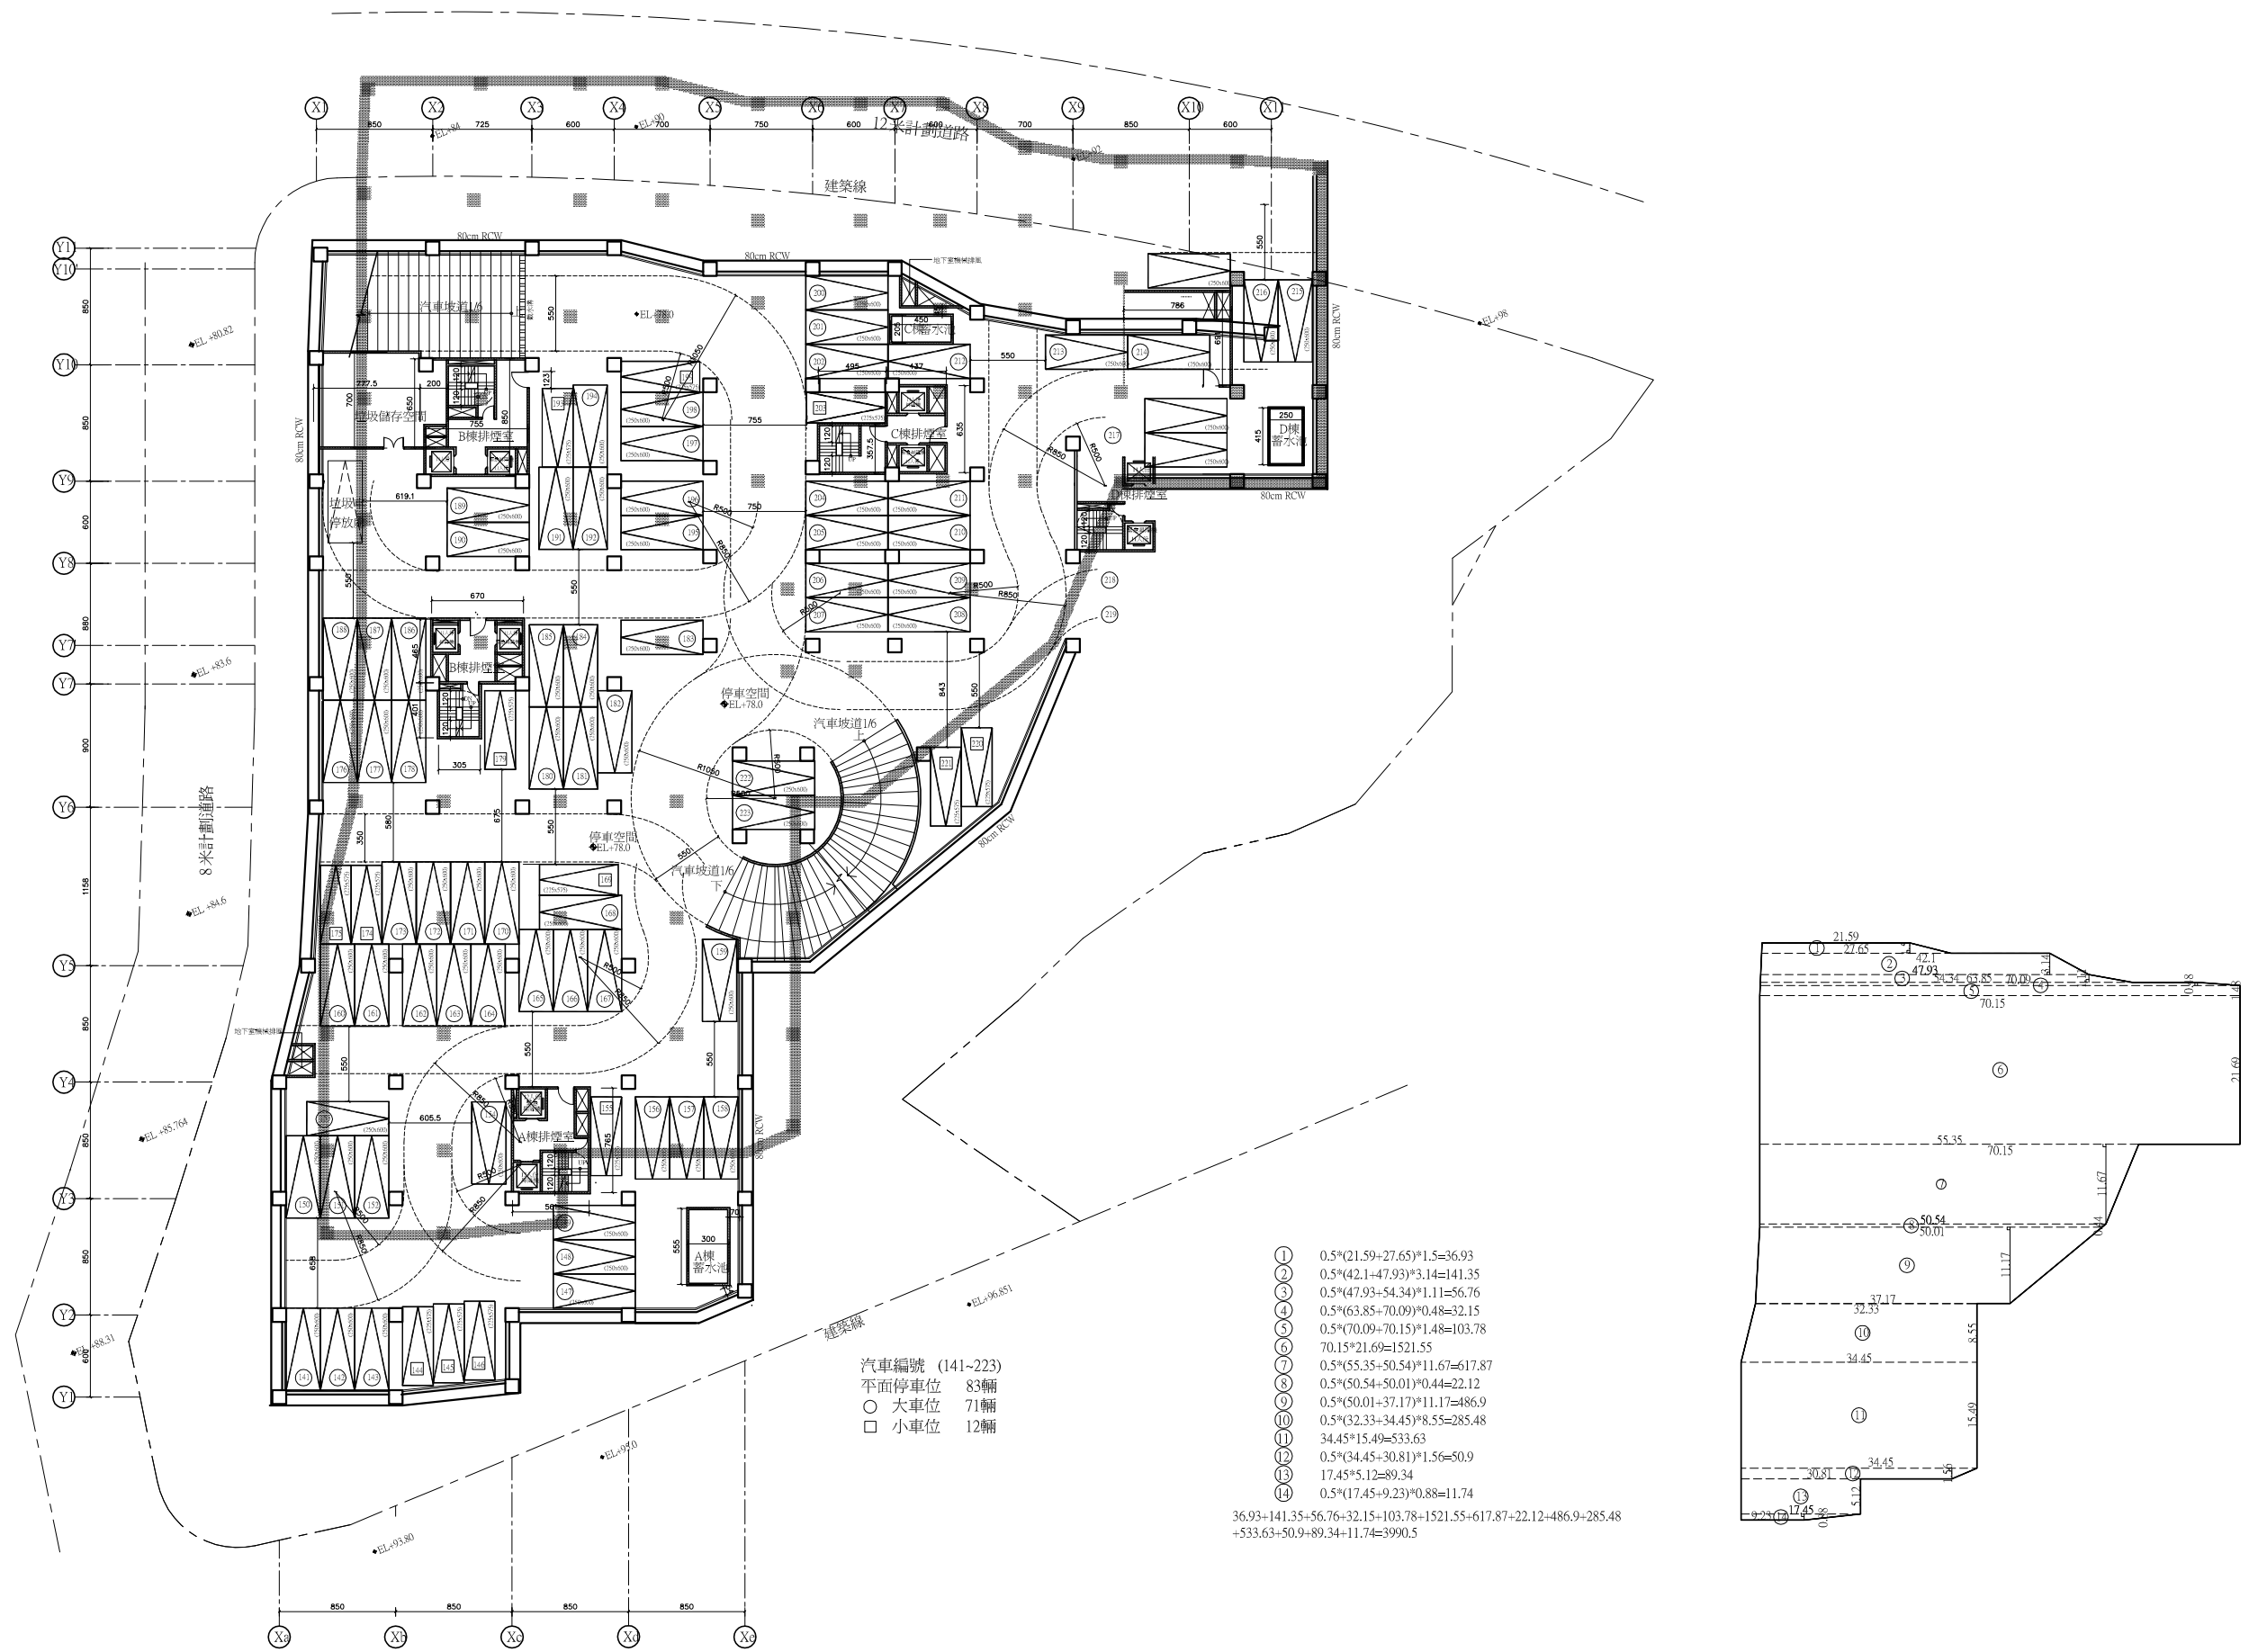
A棟地下參層 B1~B4地下貳層 B5~B9地下壹層 C棟地下肆層D棟地下伍層平面圖 Scale 1/500 (EL+78)
